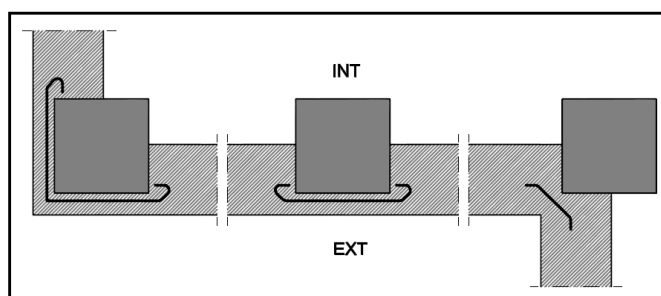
Figura 2.9 CTE DB HS1: "Ejemplo de encuentro de la fachada con los pilares"
